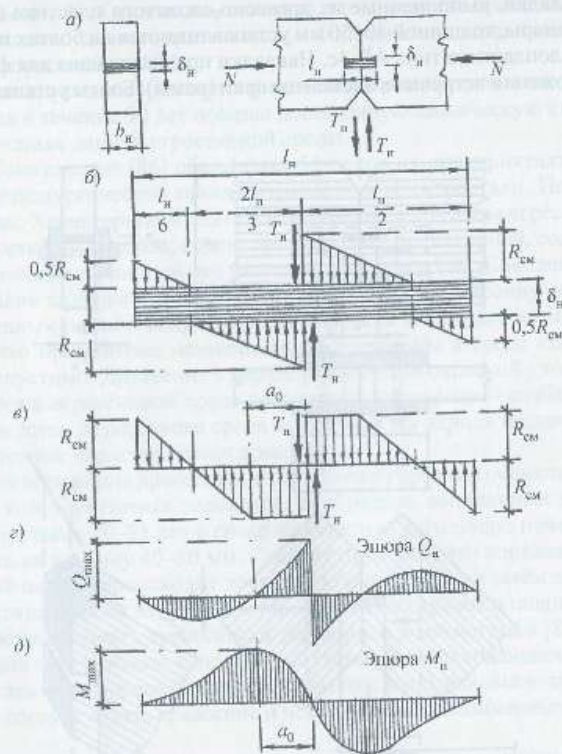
К расчету пластинчатого нагеля и нагельного гнезда: а — общая схема конструкции и силовые воздействия; б — расчетная схема нагеля при упругой работе на смятие материалов нагеля или нагельного гнезда; в — расчетная схема нагеля при упругопластической работе на смятие материалов нагеля или нагельного гнезда; г — эпюра поперечных сил в пластинчатом нагеле; д — эпюра моментов в пластинчатом нагеле
